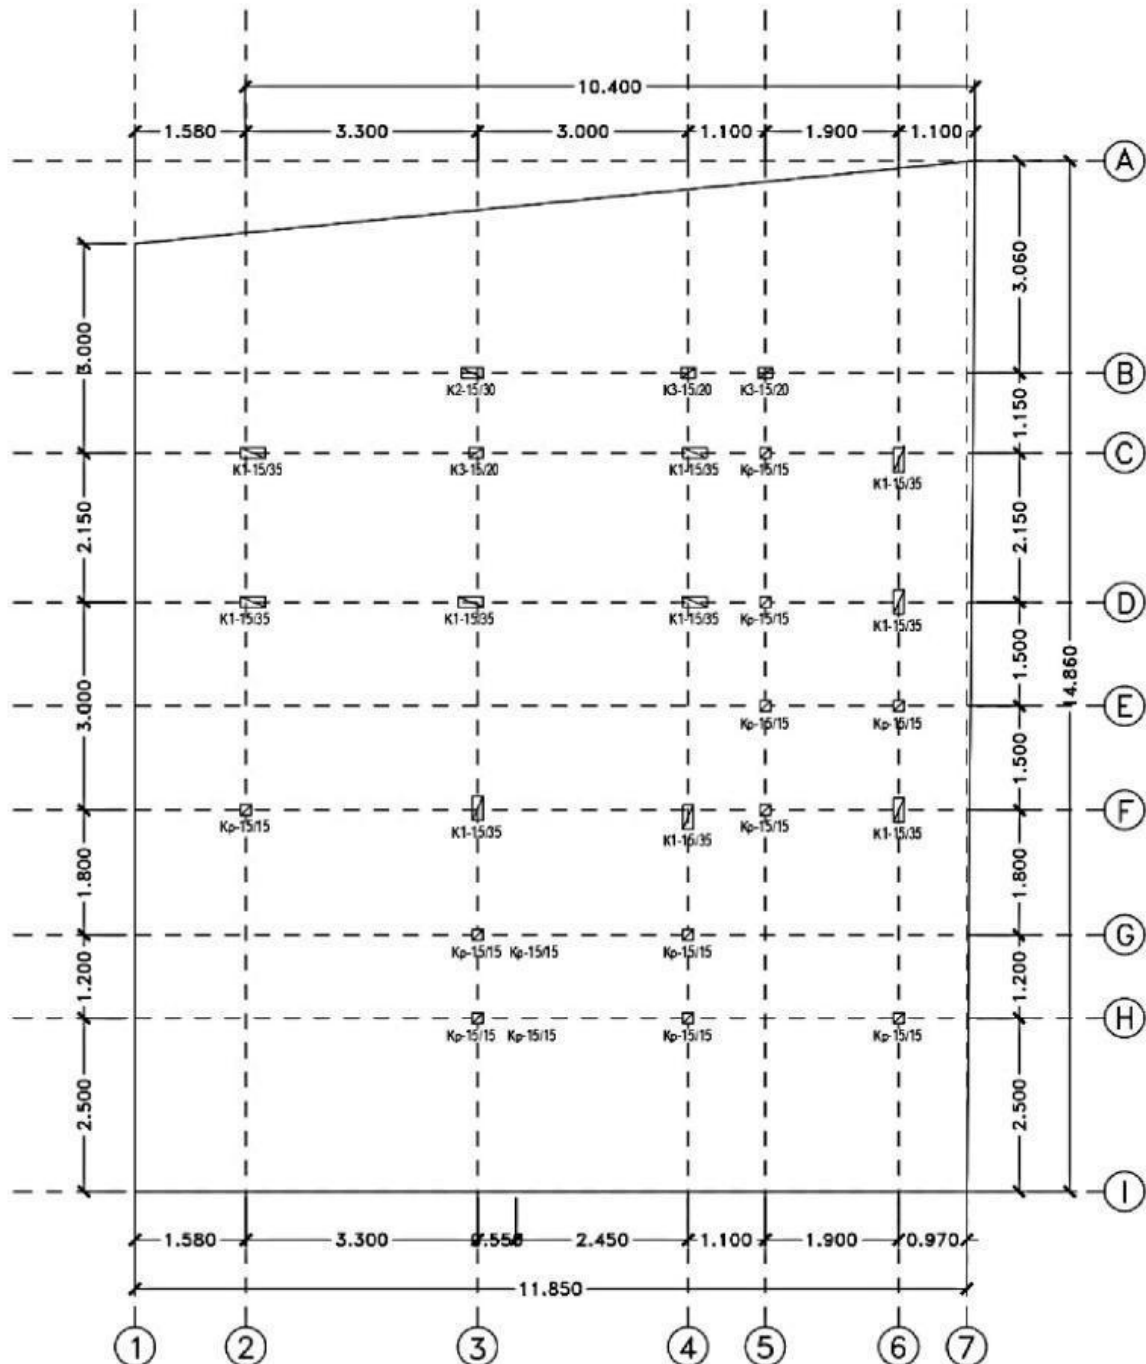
Contoh gambar denah lantai 1 pada rumah 2 lantai.
